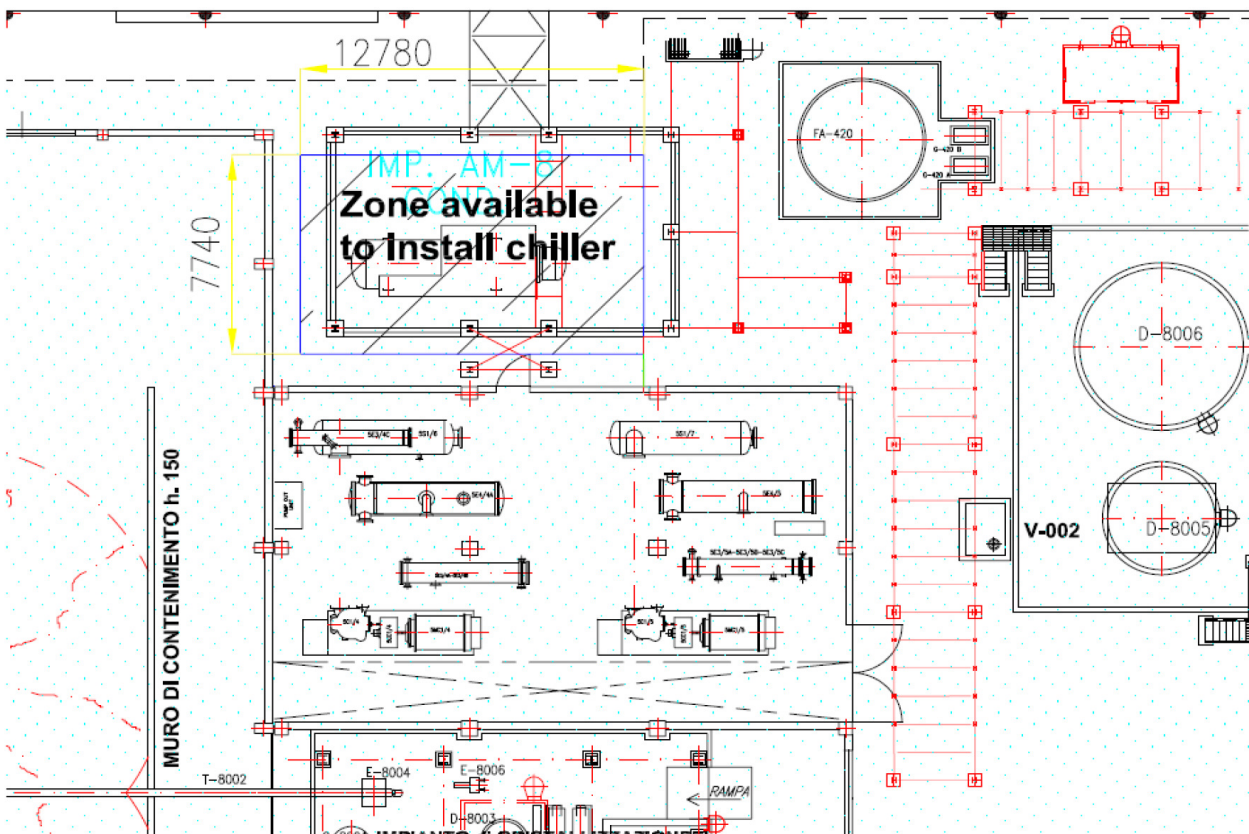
Planimetria con indicazione area di installazione del nuovo gruppo frigo
